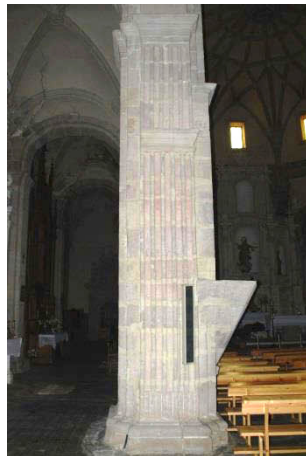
Ménsulas de apoyo en las pilastras para apoyo del coro.
